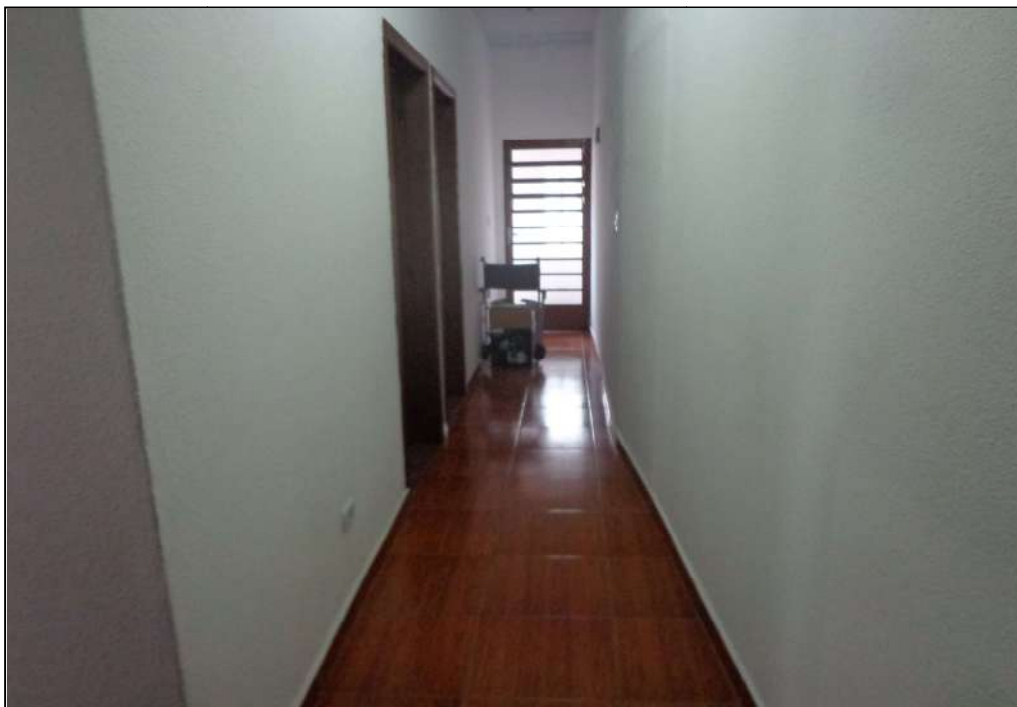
Vista interna do imóvel (n.º 167 – Casa 2).
